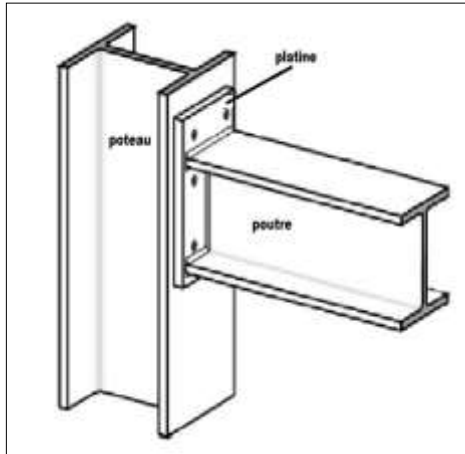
Assemblage boulonné d'une poutre à l'âme d'un poteau
